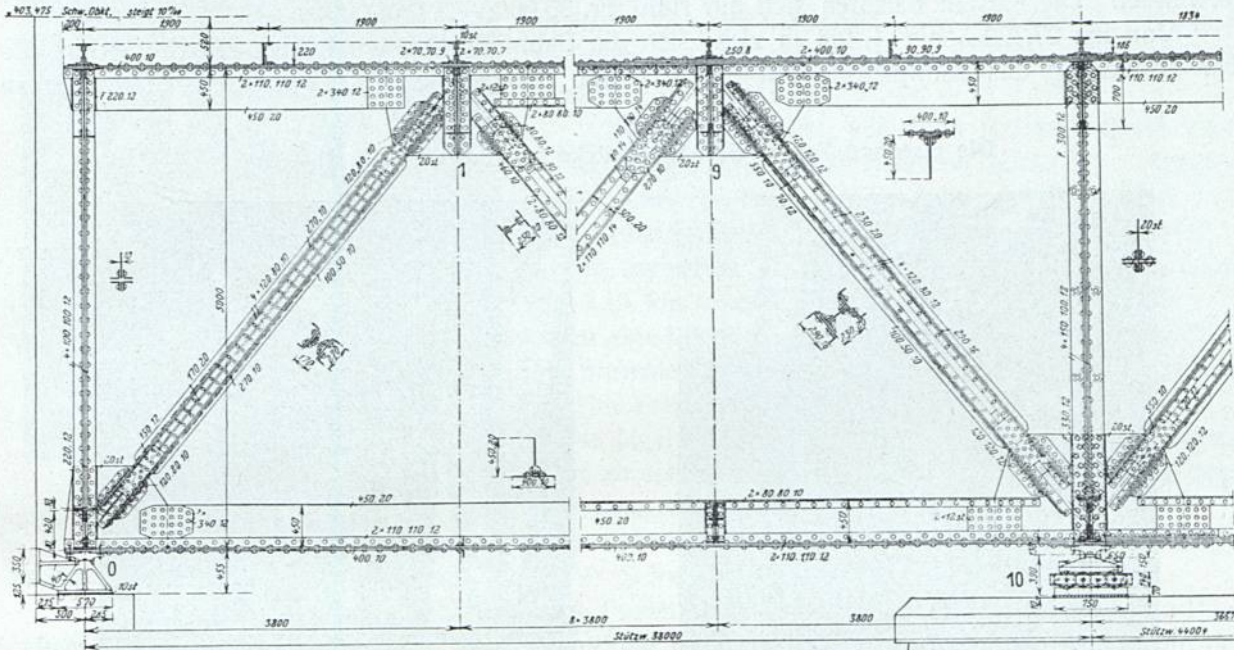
Hauptträger mit festem Lager sowie mit beweglichem Lager bei den Mittelpfeilern.
